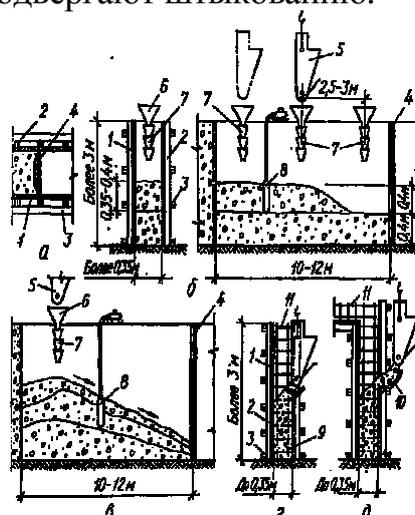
Схемы бетонирования стен: а — установка разделительной опалубки; б — послойное бетонирование стен; в — то же, но неправильное с подачей бетона в одну точку; г, д —
